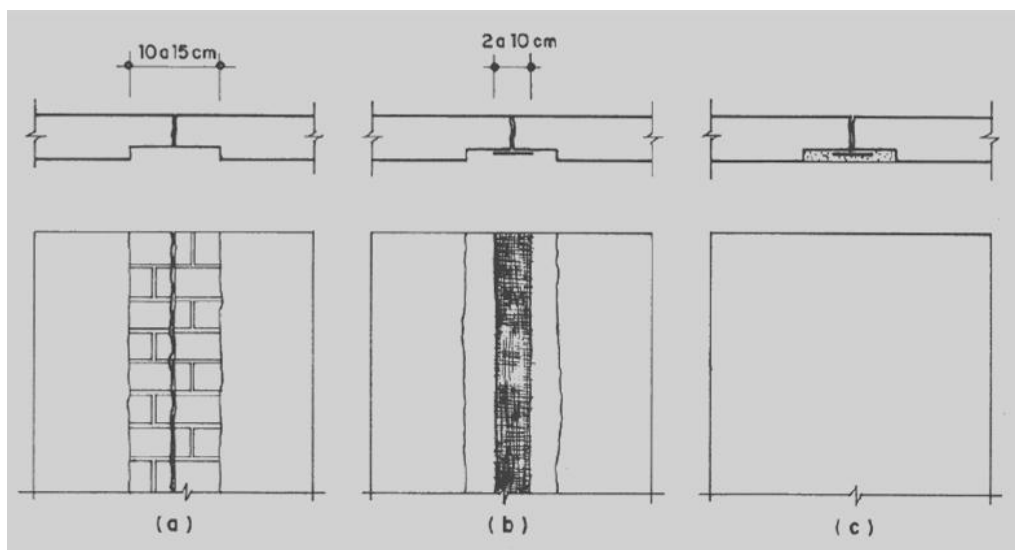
Correção de fissuras nas alvenarias com tela metálica
